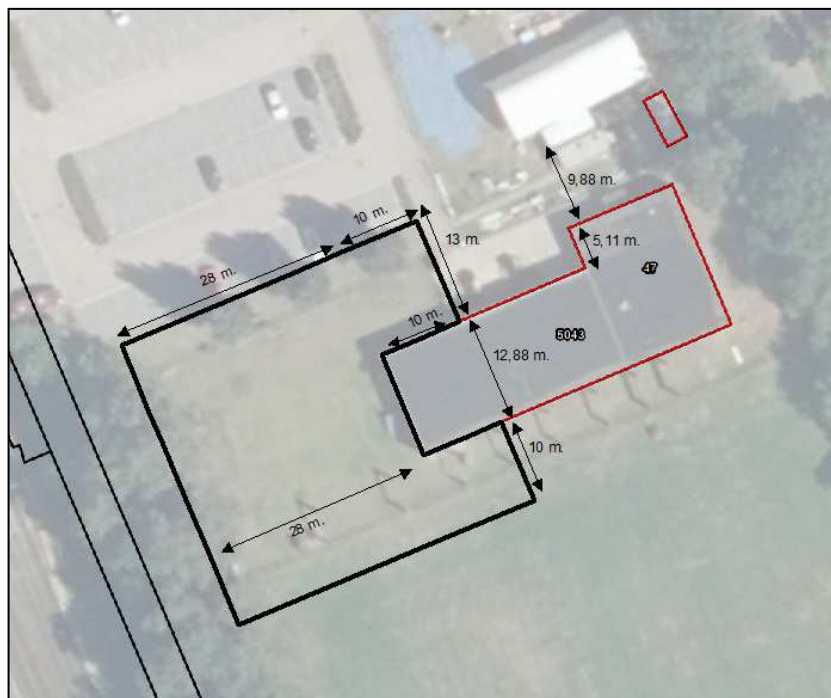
Foto parkeerplaats met de tijdelijke bouwplaats voor praalwagens
